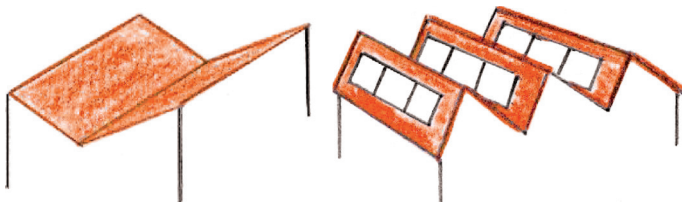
tetto a farfalla e tetto a shed. Fonte: www.dach.de/tools/dachformen
